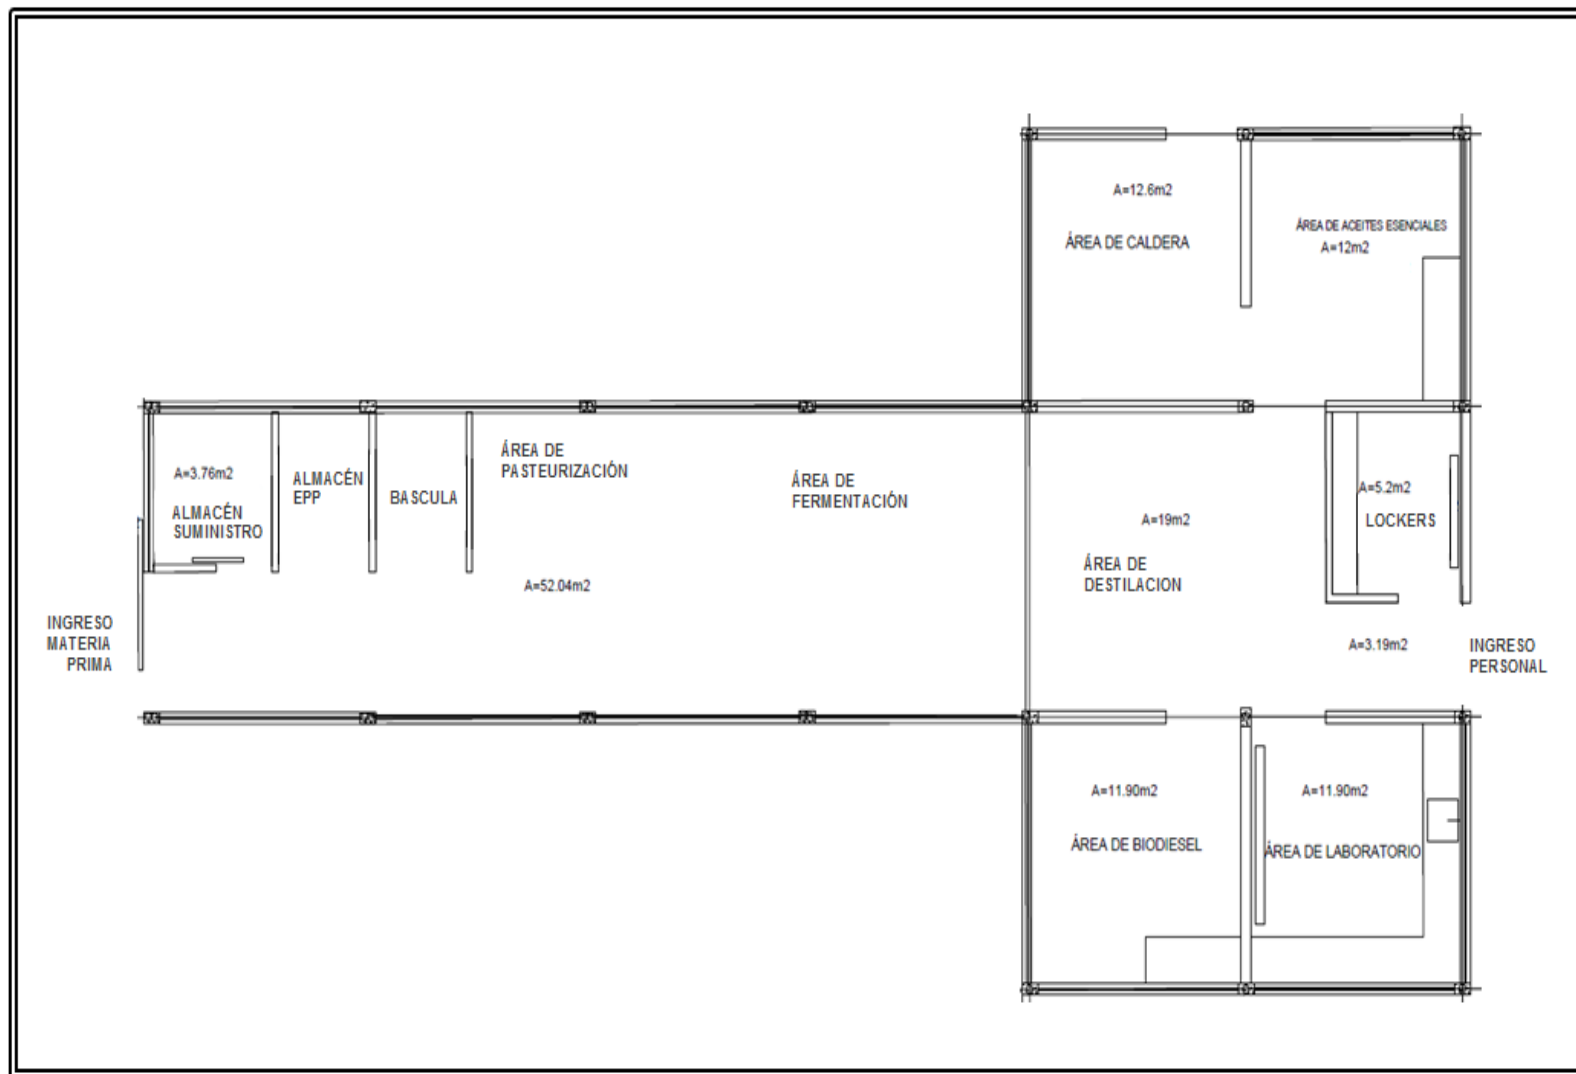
Plano de distribución general de la planta. (Fuente: el autor)
